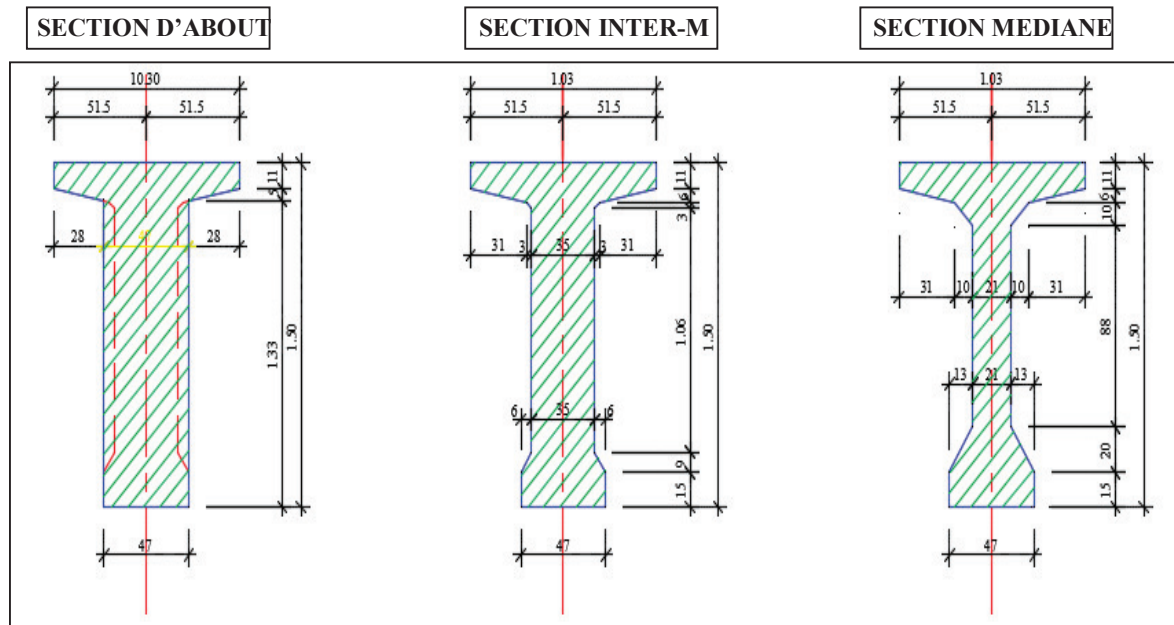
Différentes sections de la poutre de la variante VIPP.
